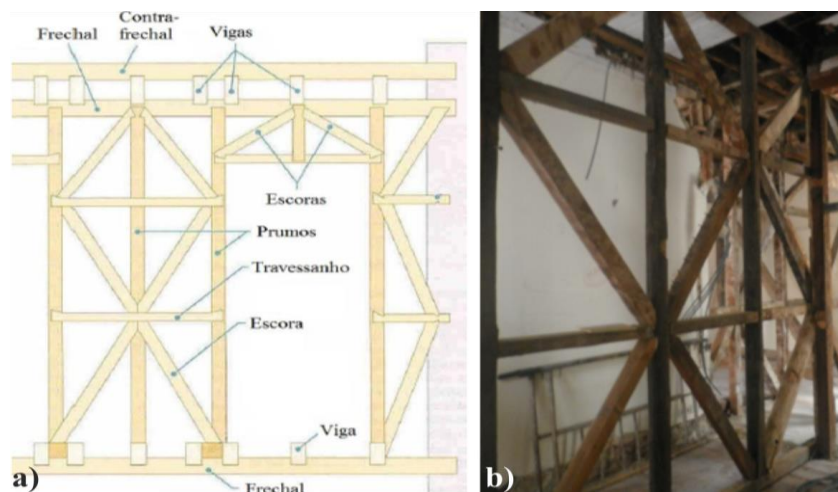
a) Esquema de uma parede de frontal (Andrade, 2011); b) Estrutura de madeira de uma parede de frontal reconstruída num edifício na Calçada do Sacramento, Lisboa
